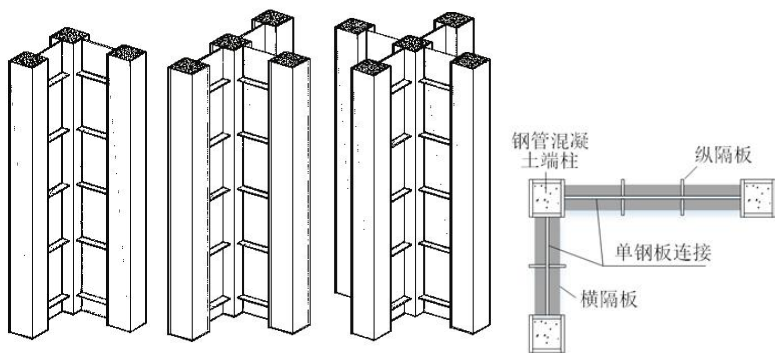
单板连接型矩形钢管混凝土组合异形柱
